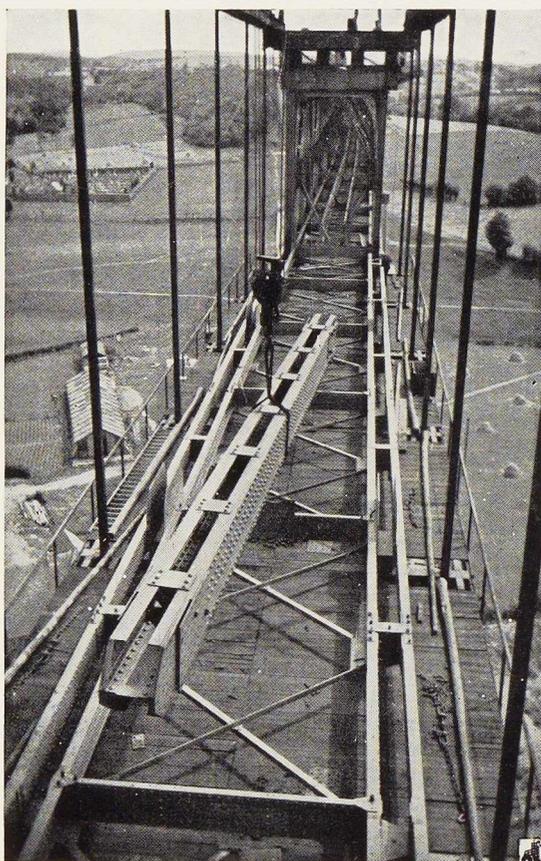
Vue du plancher de travail et d'un tablier en cours de montage.
